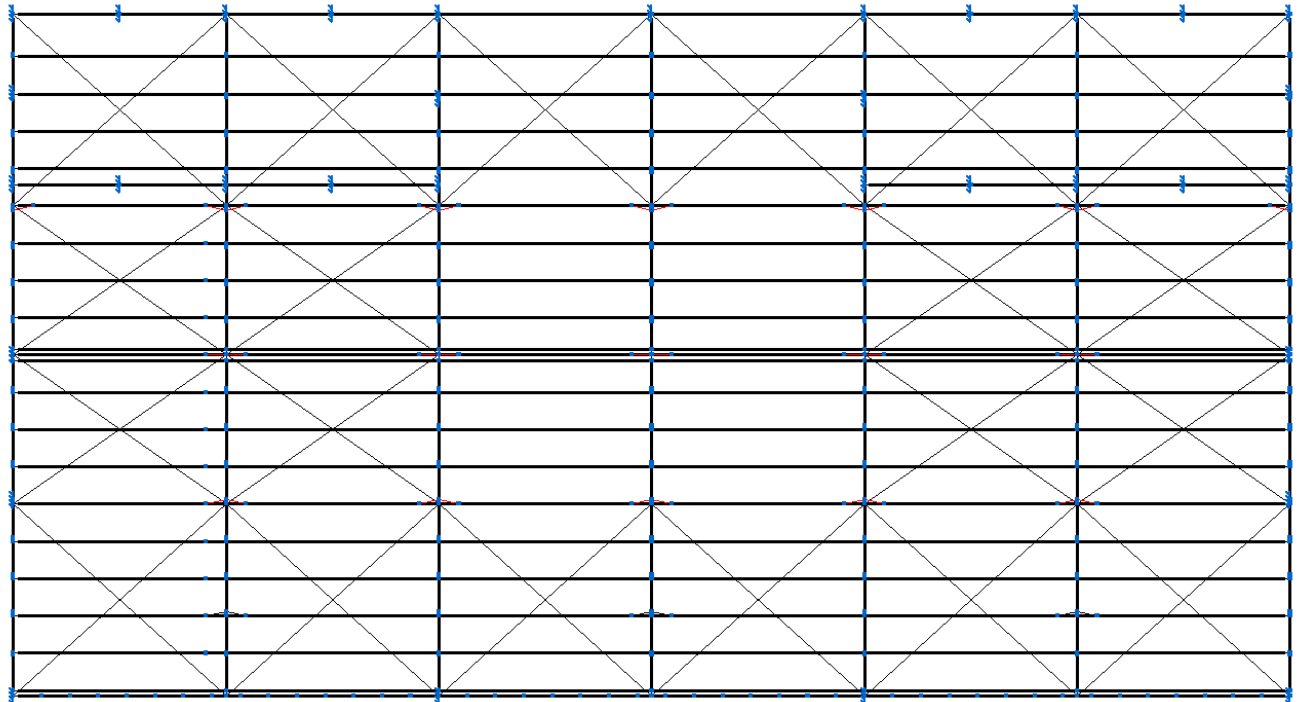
Estructura Alambrica - Cubierta. Fuente: Elaboración propia.
